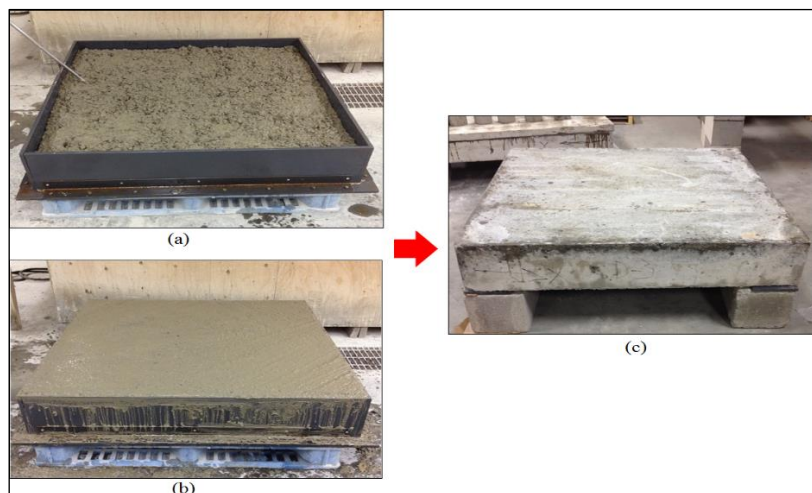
Dalle N° 3, (a) Mise en place du béton, (b) Remplissage du moule, (c) Dalle monolithique finale.
